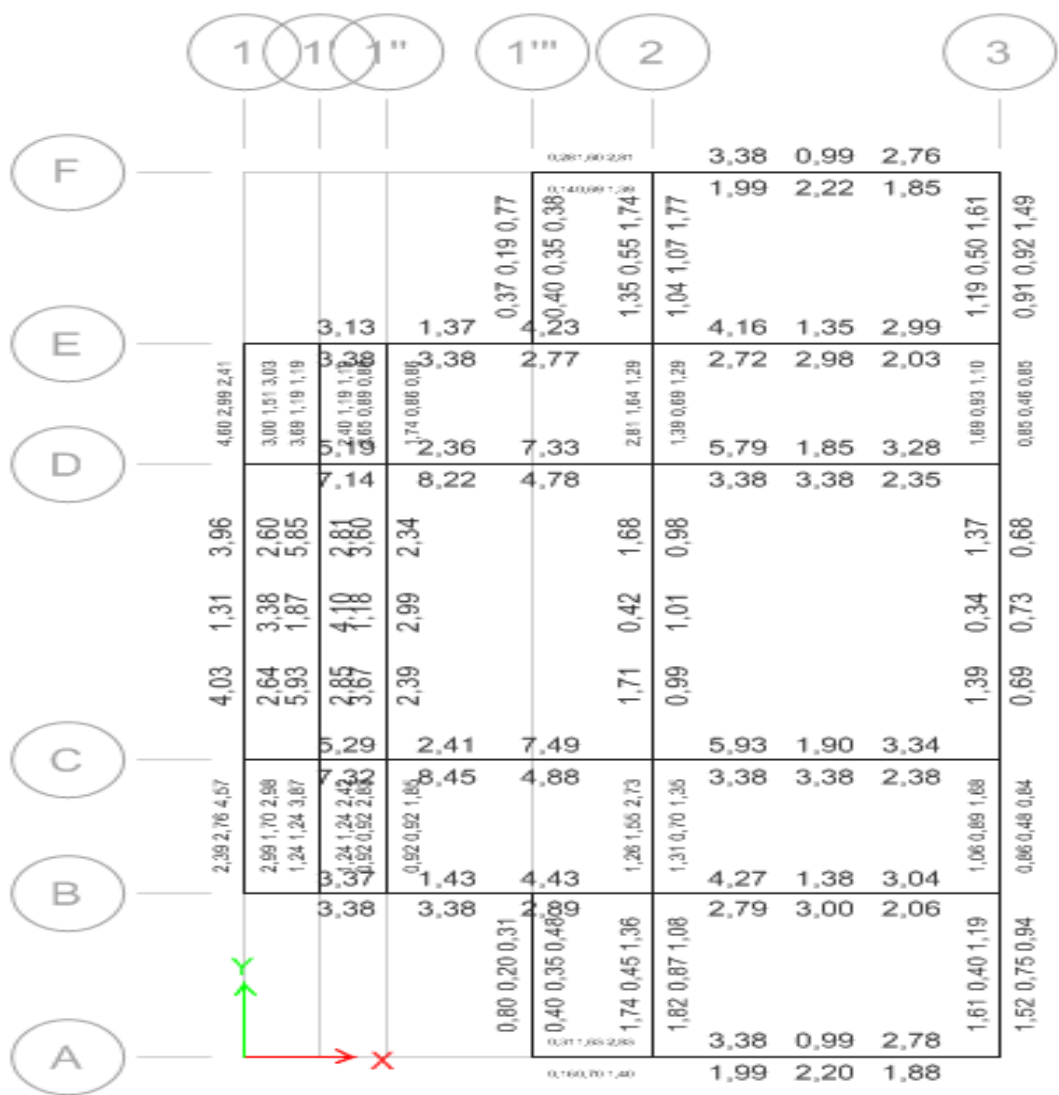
Refuerzo Longitudinal vigas de cubierta de la cocina N+3.60. Cm2
